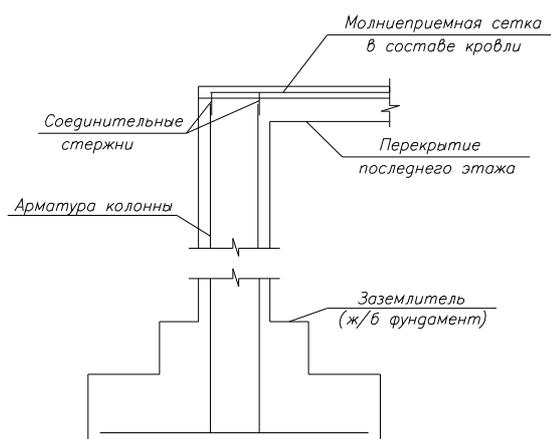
Молниезащита здания сеткой уложенной под кровлю здания
